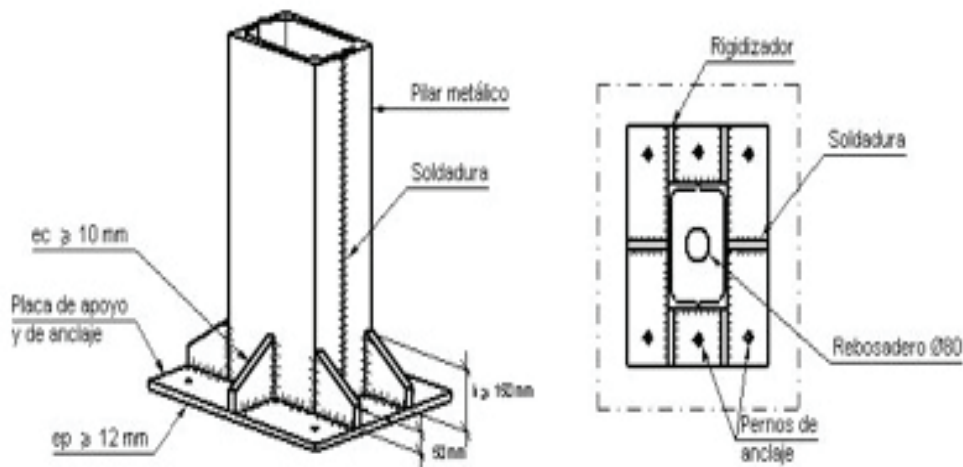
Detalle anclaje perfiles UPN a la cimentación mediante placas de apoyo.
